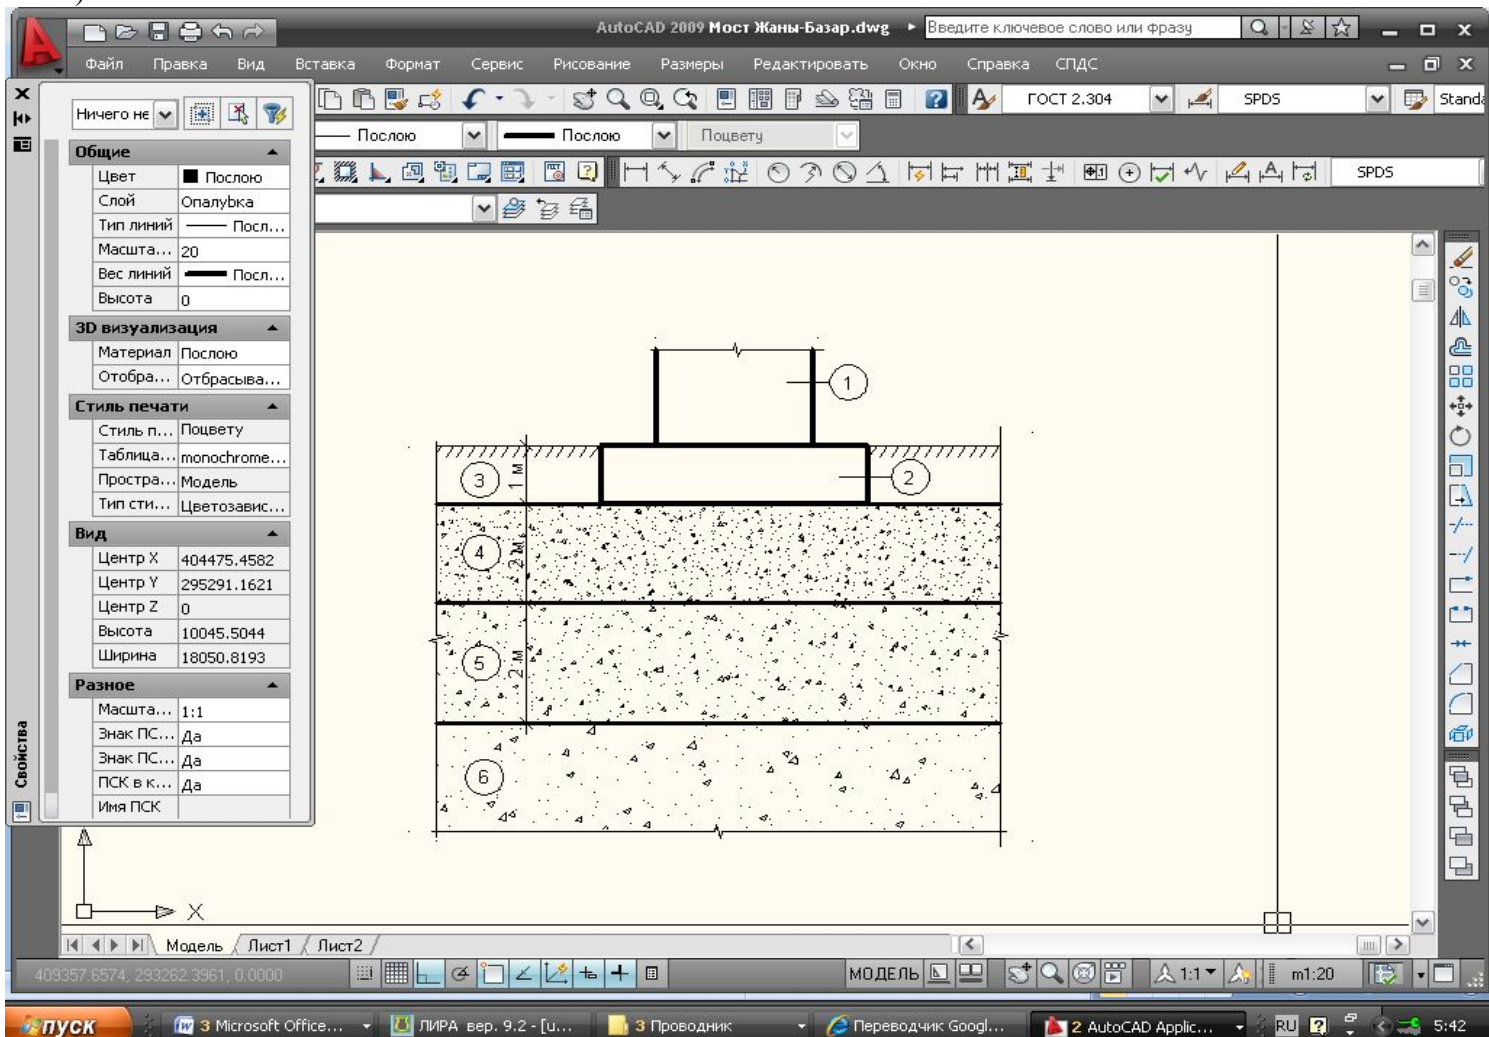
Фундамент и основания промежуточной опоры подземного перехода.
